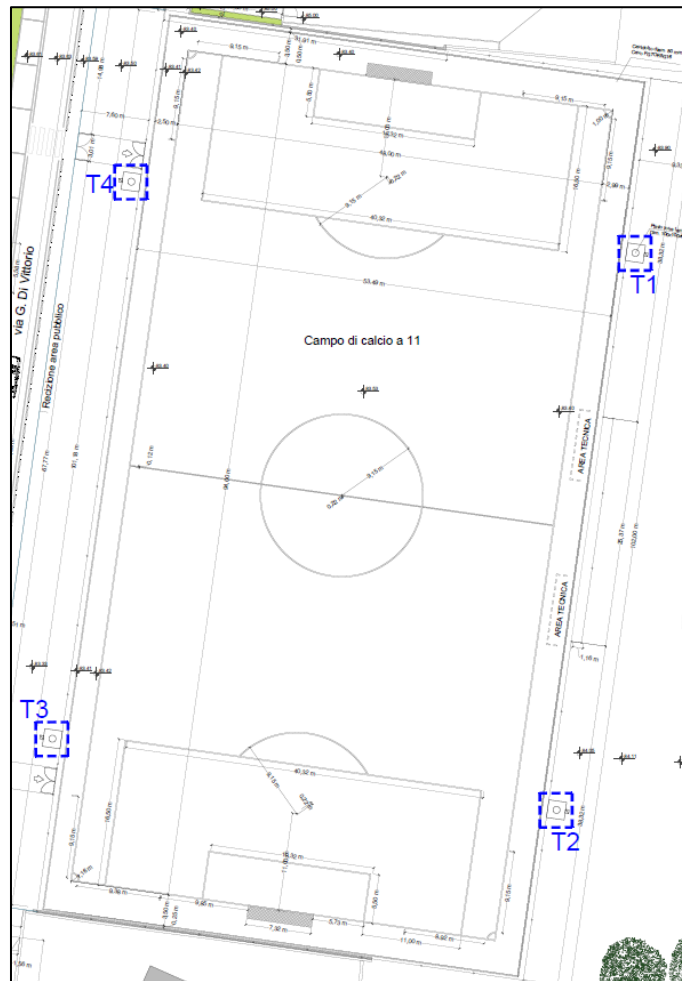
Planimetria Campo Sussidiario con indicazione delle torri faro
